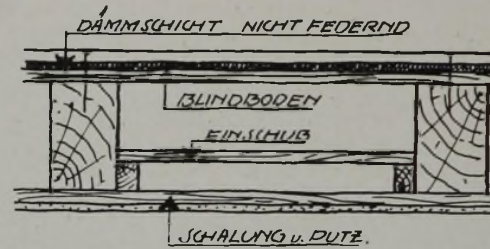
Normale Holzbalkendecke ohne Füllung. Eine zufriedenstellende Dämmung wird nur erreicht, wenn die
